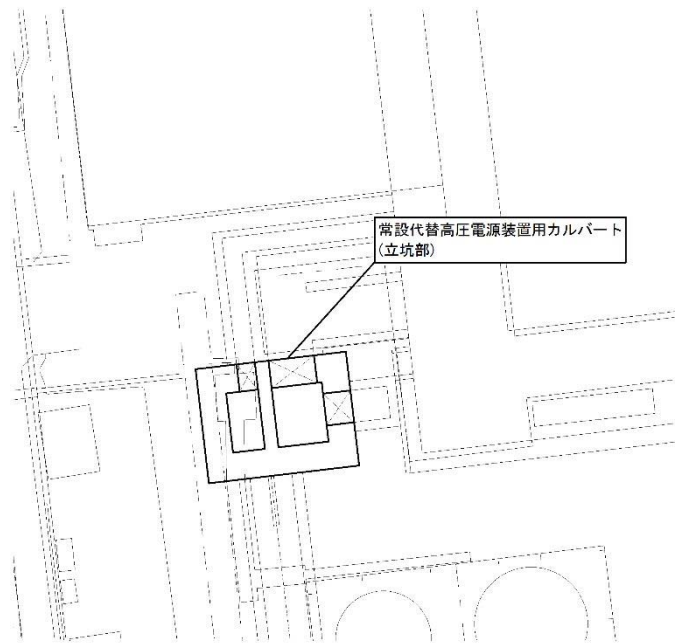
(1) 常設代替高圧電源装置用カルバート（立坑部）平面配置図（拡大図）
